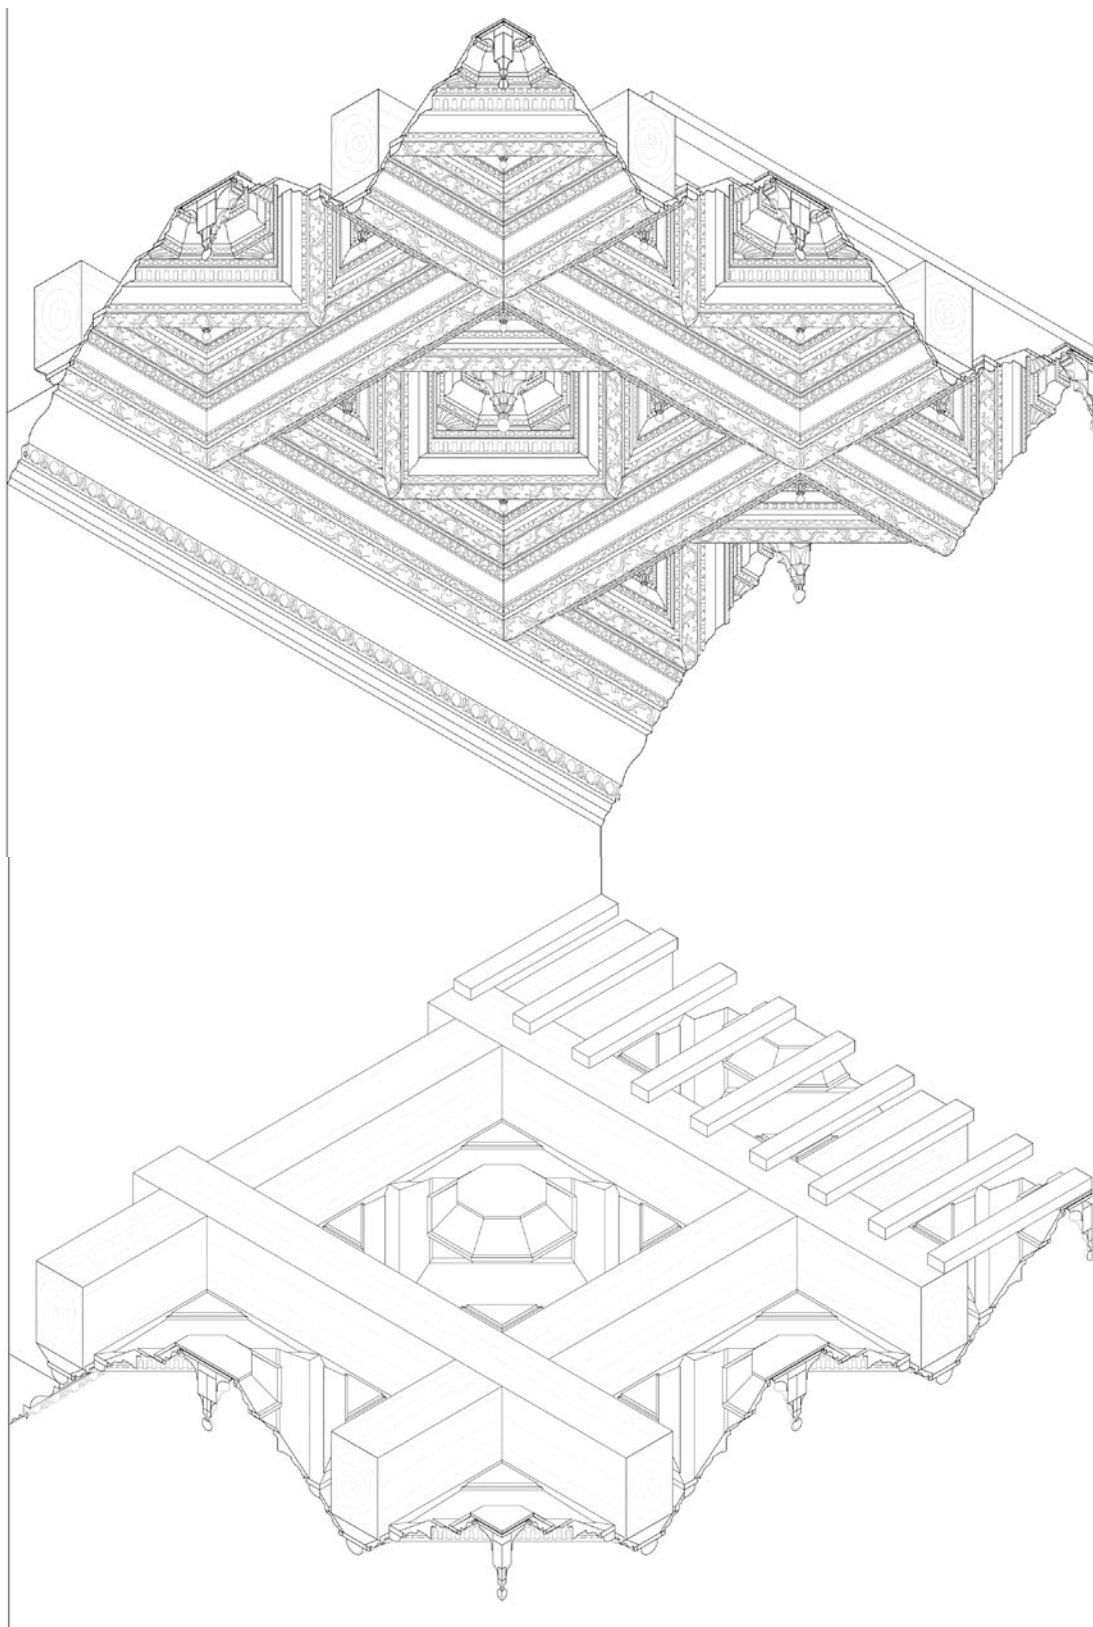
Axonometría de un artesonado tipo. Vista inferior y vista superior.
